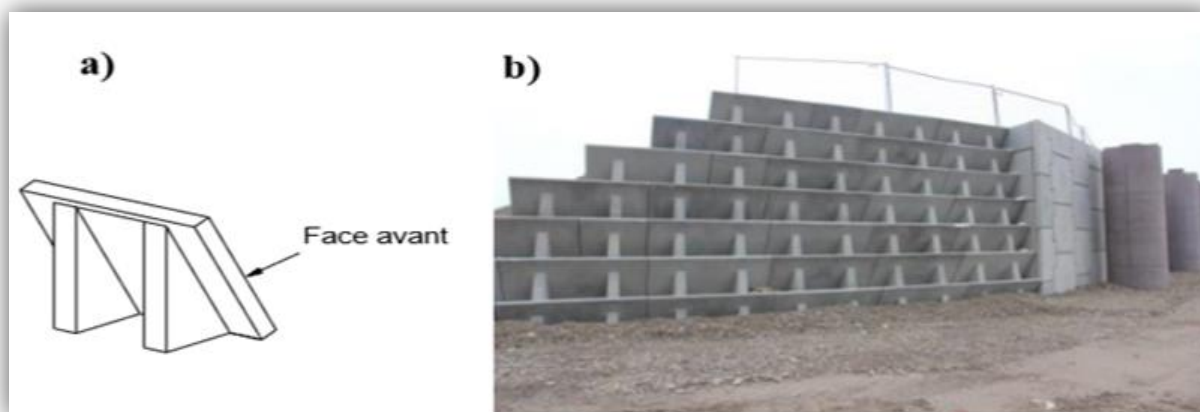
Panneau incliné préétablie : a) NF EN 14475 ; b) Terre Armée
